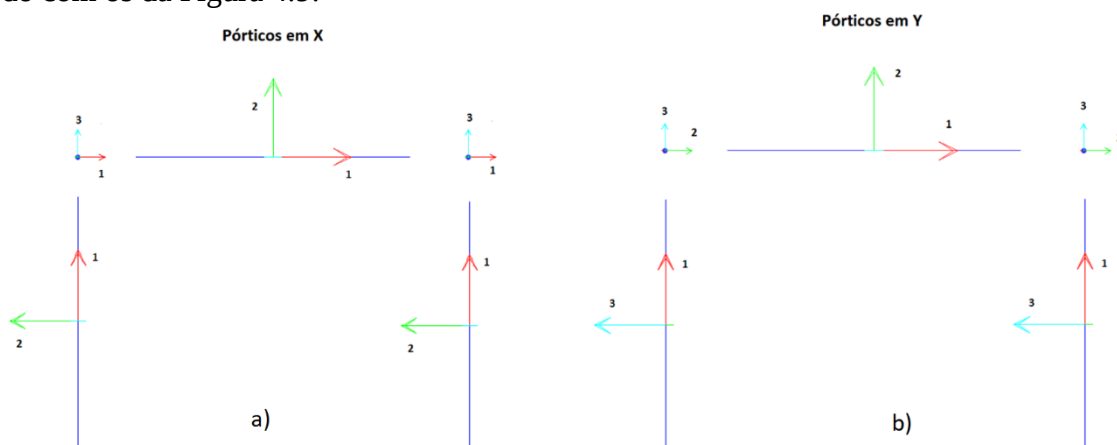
Eixos locais dos pilares, vigas e nós condizentes com cada folha de cálculo: a) pórticos em X e b) pórticos em Y.
